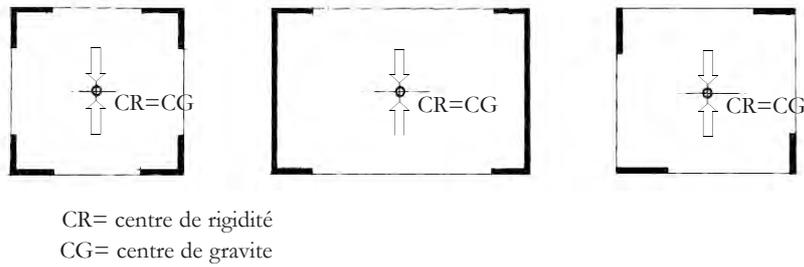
Localisation correcte des éléments de contreventement vertical.
